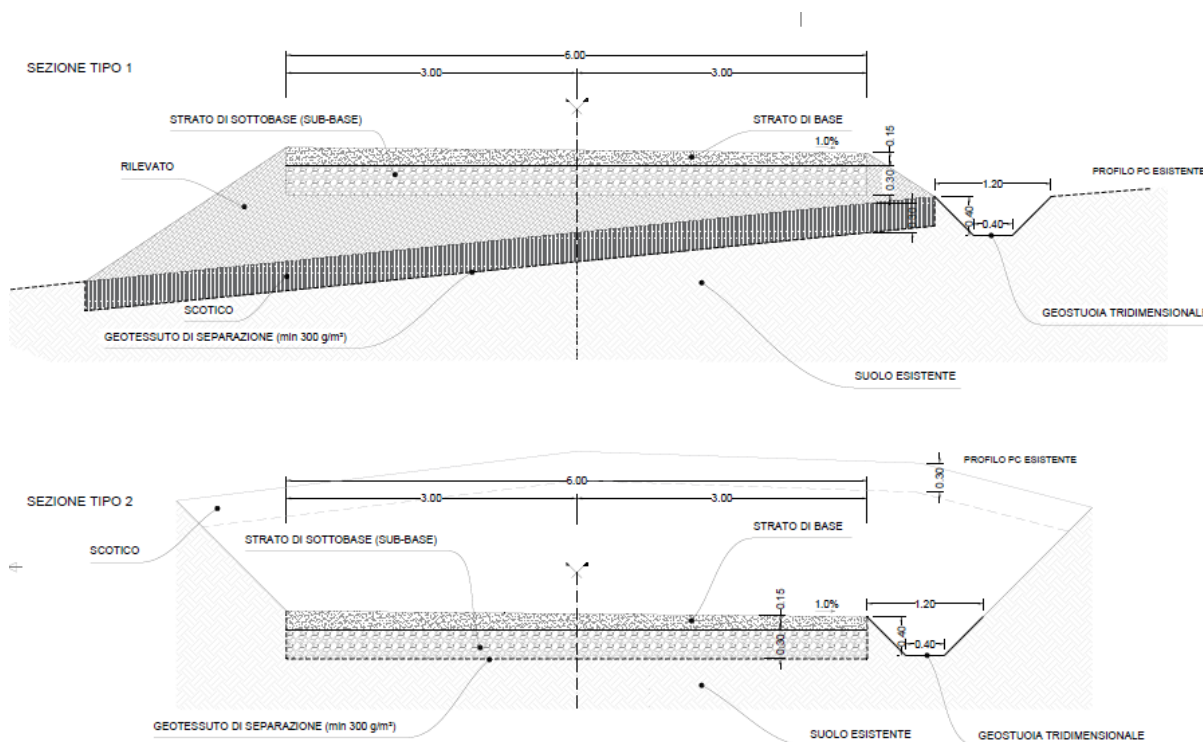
Sezione trasversale viabilità di nuova realizzazione. Fonte: elaborato di progetto "GRE.EEC.D.73.IT.W.15235.12.021.00_ Sezione stradale tipo e particolari costruttivi"
